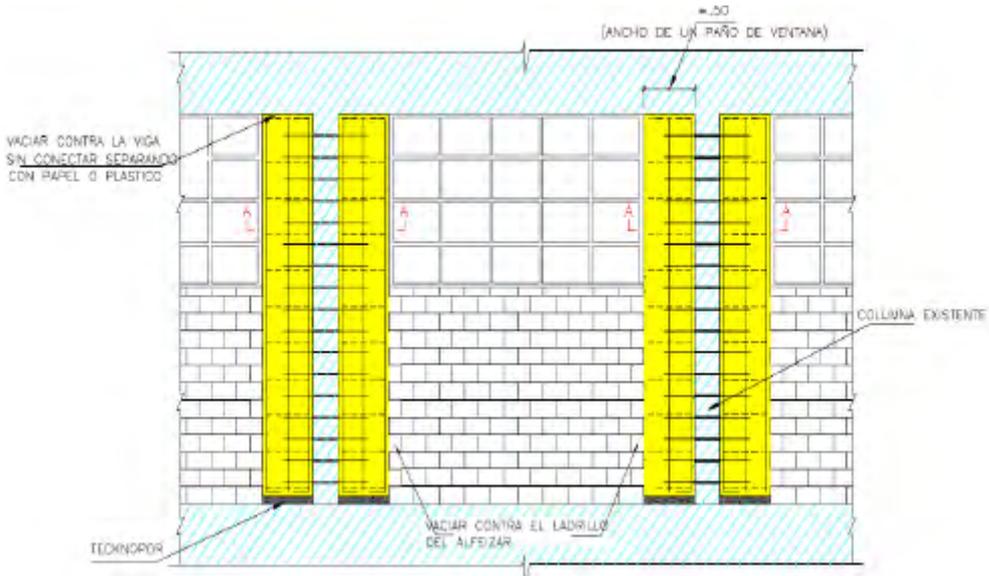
Vista de la elevación del refuerzo con aletas de concreto (Fuente: Informe DAI, 2007)
